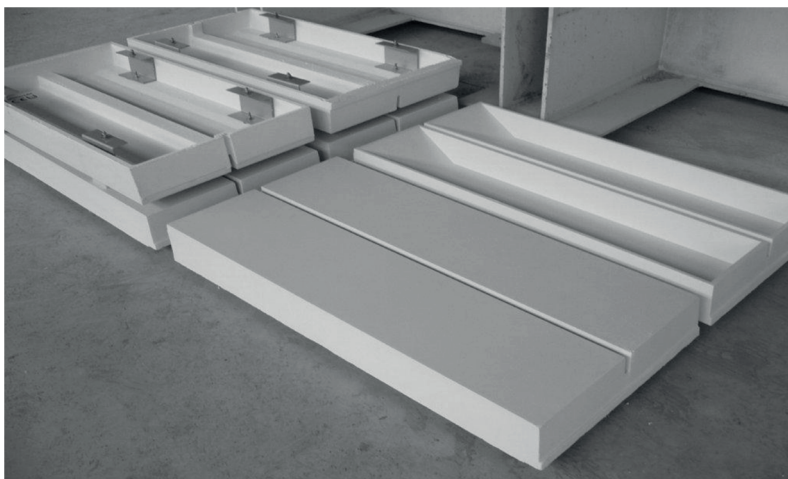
Beispiele der Fassadenelemente mit Befestigungsankern
